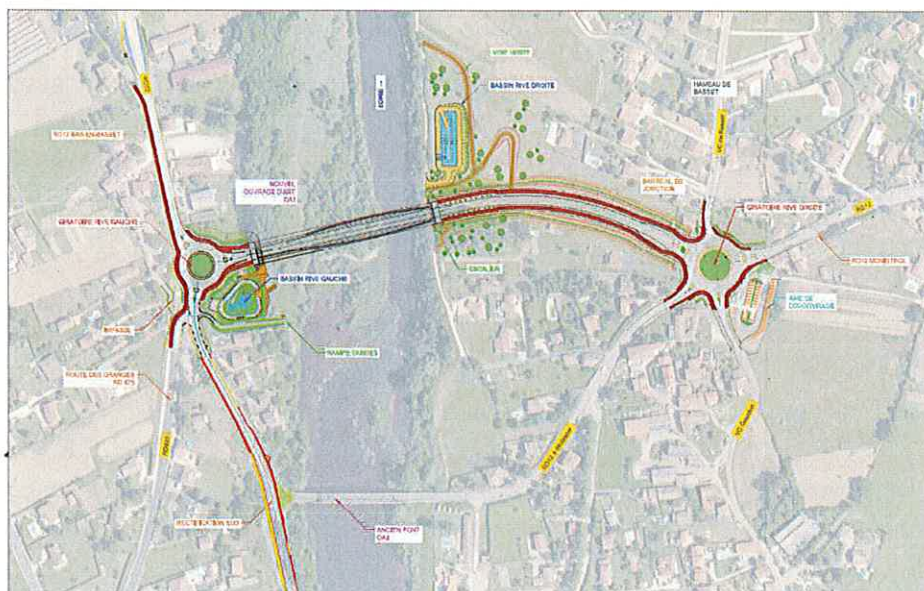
Projet du nouveau pont sur la Loire (source : Département de la Haute-Loire)
